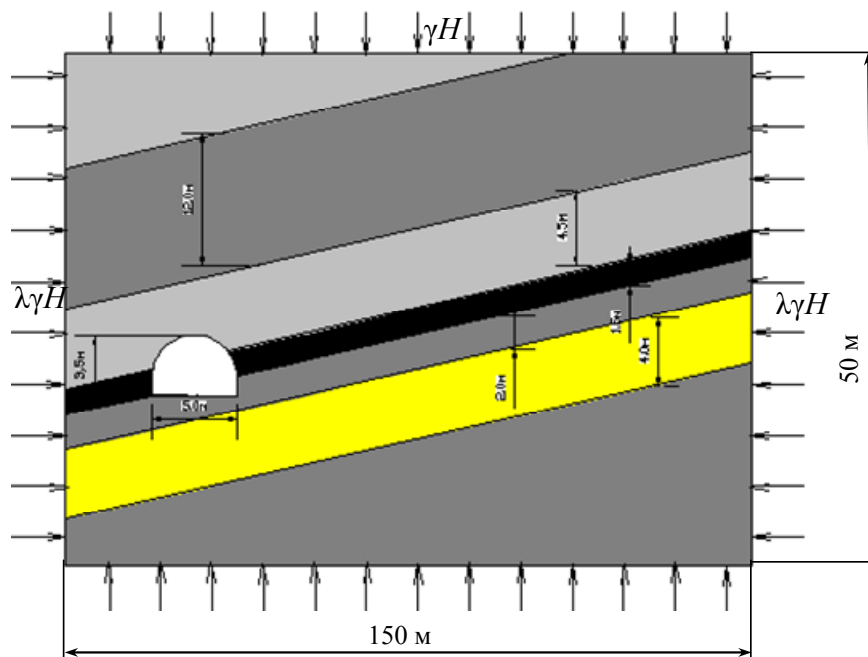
Расчетная схема к решению задачи обоснования способа охраны и поддержания подготовительных выработок
